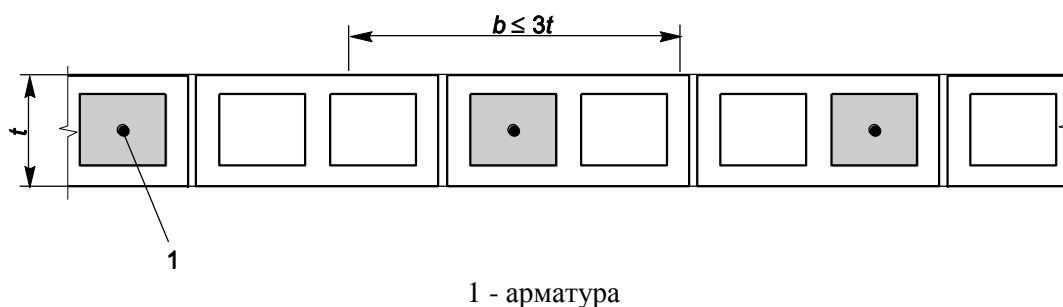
Ширина поперечного сечения в армокаменных элементах с локально сосредоточенной арматурой [СН РК EN 1996-1-1:2005/2011]
